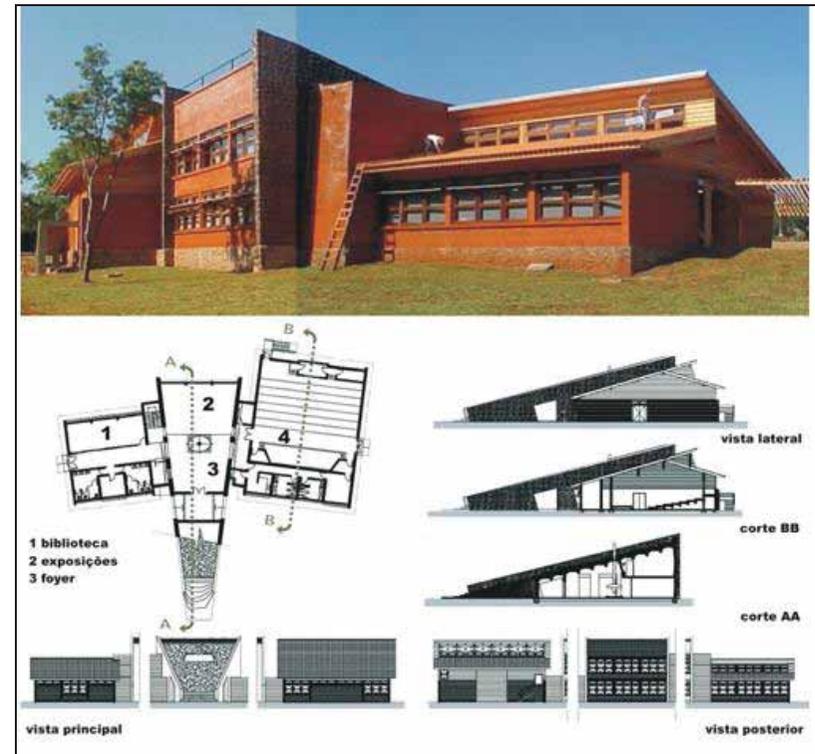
Centro de recepção ao visitante- Vista, Cortes, planta. Fonte: <http://www.lerodrigues.arq.br>
